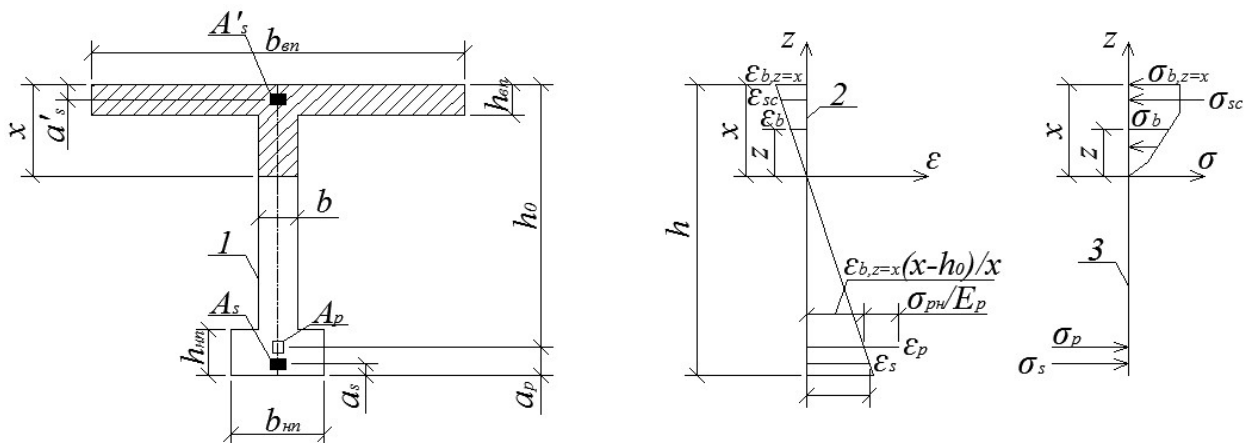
Схемы к деформационному расчёту изгибаемых железобетонных балок со смешанным армированием: 1 – поперечное сечение балки, 2 – эпюры распределения деформаций по высоте сечения балки, 3 – эпюры распределения напряжений по высоте сечения балки
